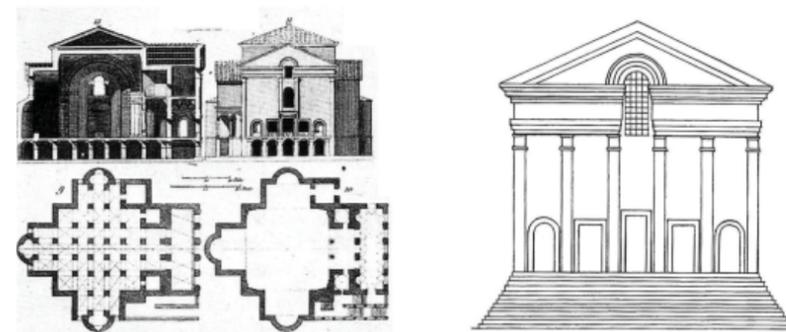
Zentralbau, Kirchenraum S. Sebastiano, Mantua, Grundriss, Schnit, Ansicht
